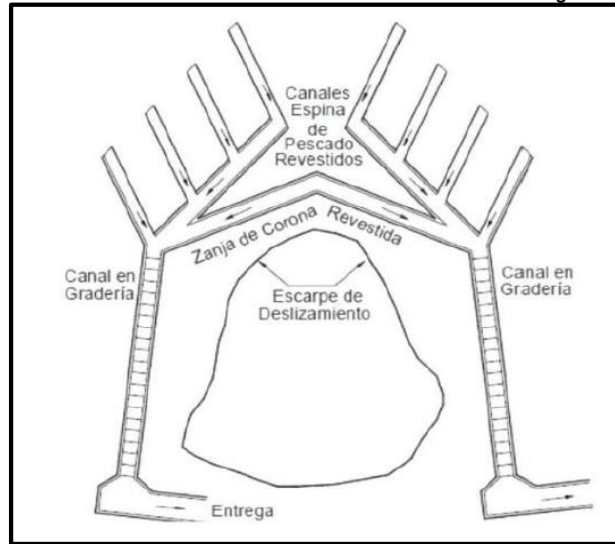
Esquema en planta de canales colectores. Espina de Pescado (Juarez, J.2010).
